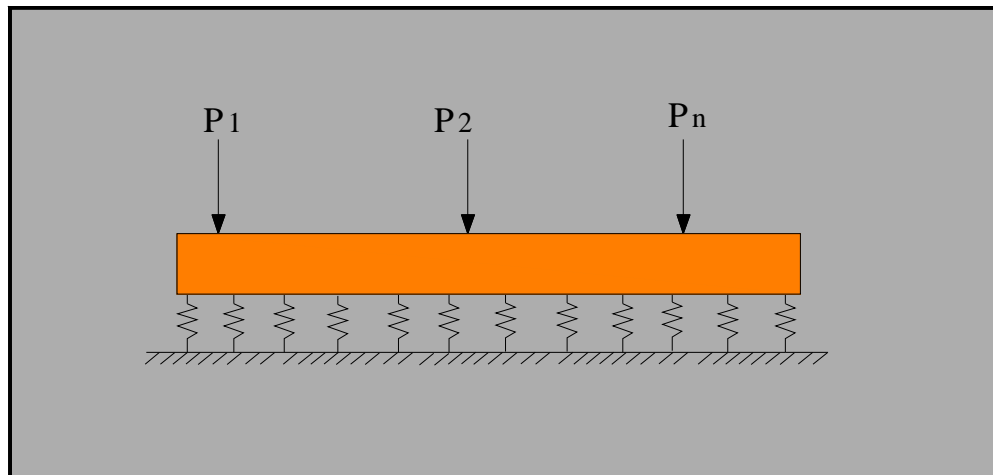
Vigas de fundación sobre lecho elástico.
